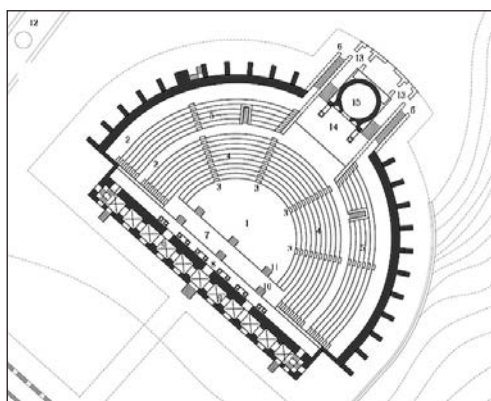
Plano del "odeón" procedente de la planta del Digital Hadrian's Villa Project (Foto: whl.clas.virginia.edu).
